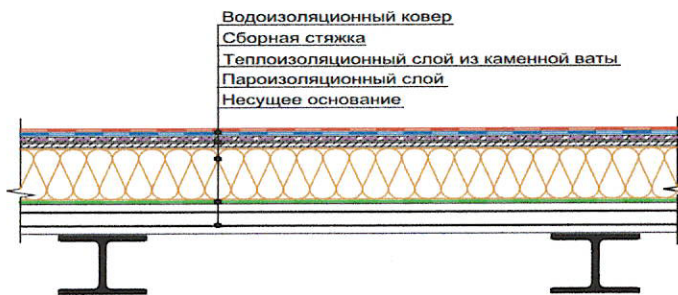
Крыша с теплоизоляционным слоем из минеральной ваты, с устройством сборной стяжки. Уклон основания под кровлю задан плитой покрытия.
